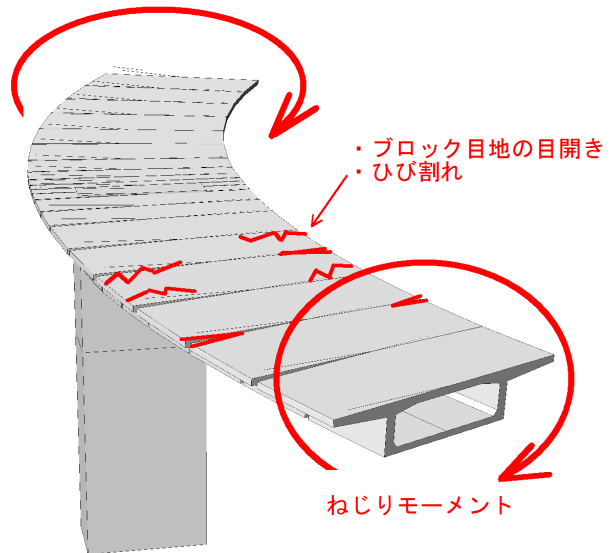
ブロック目地の目開き・ひび割れイメージ図
